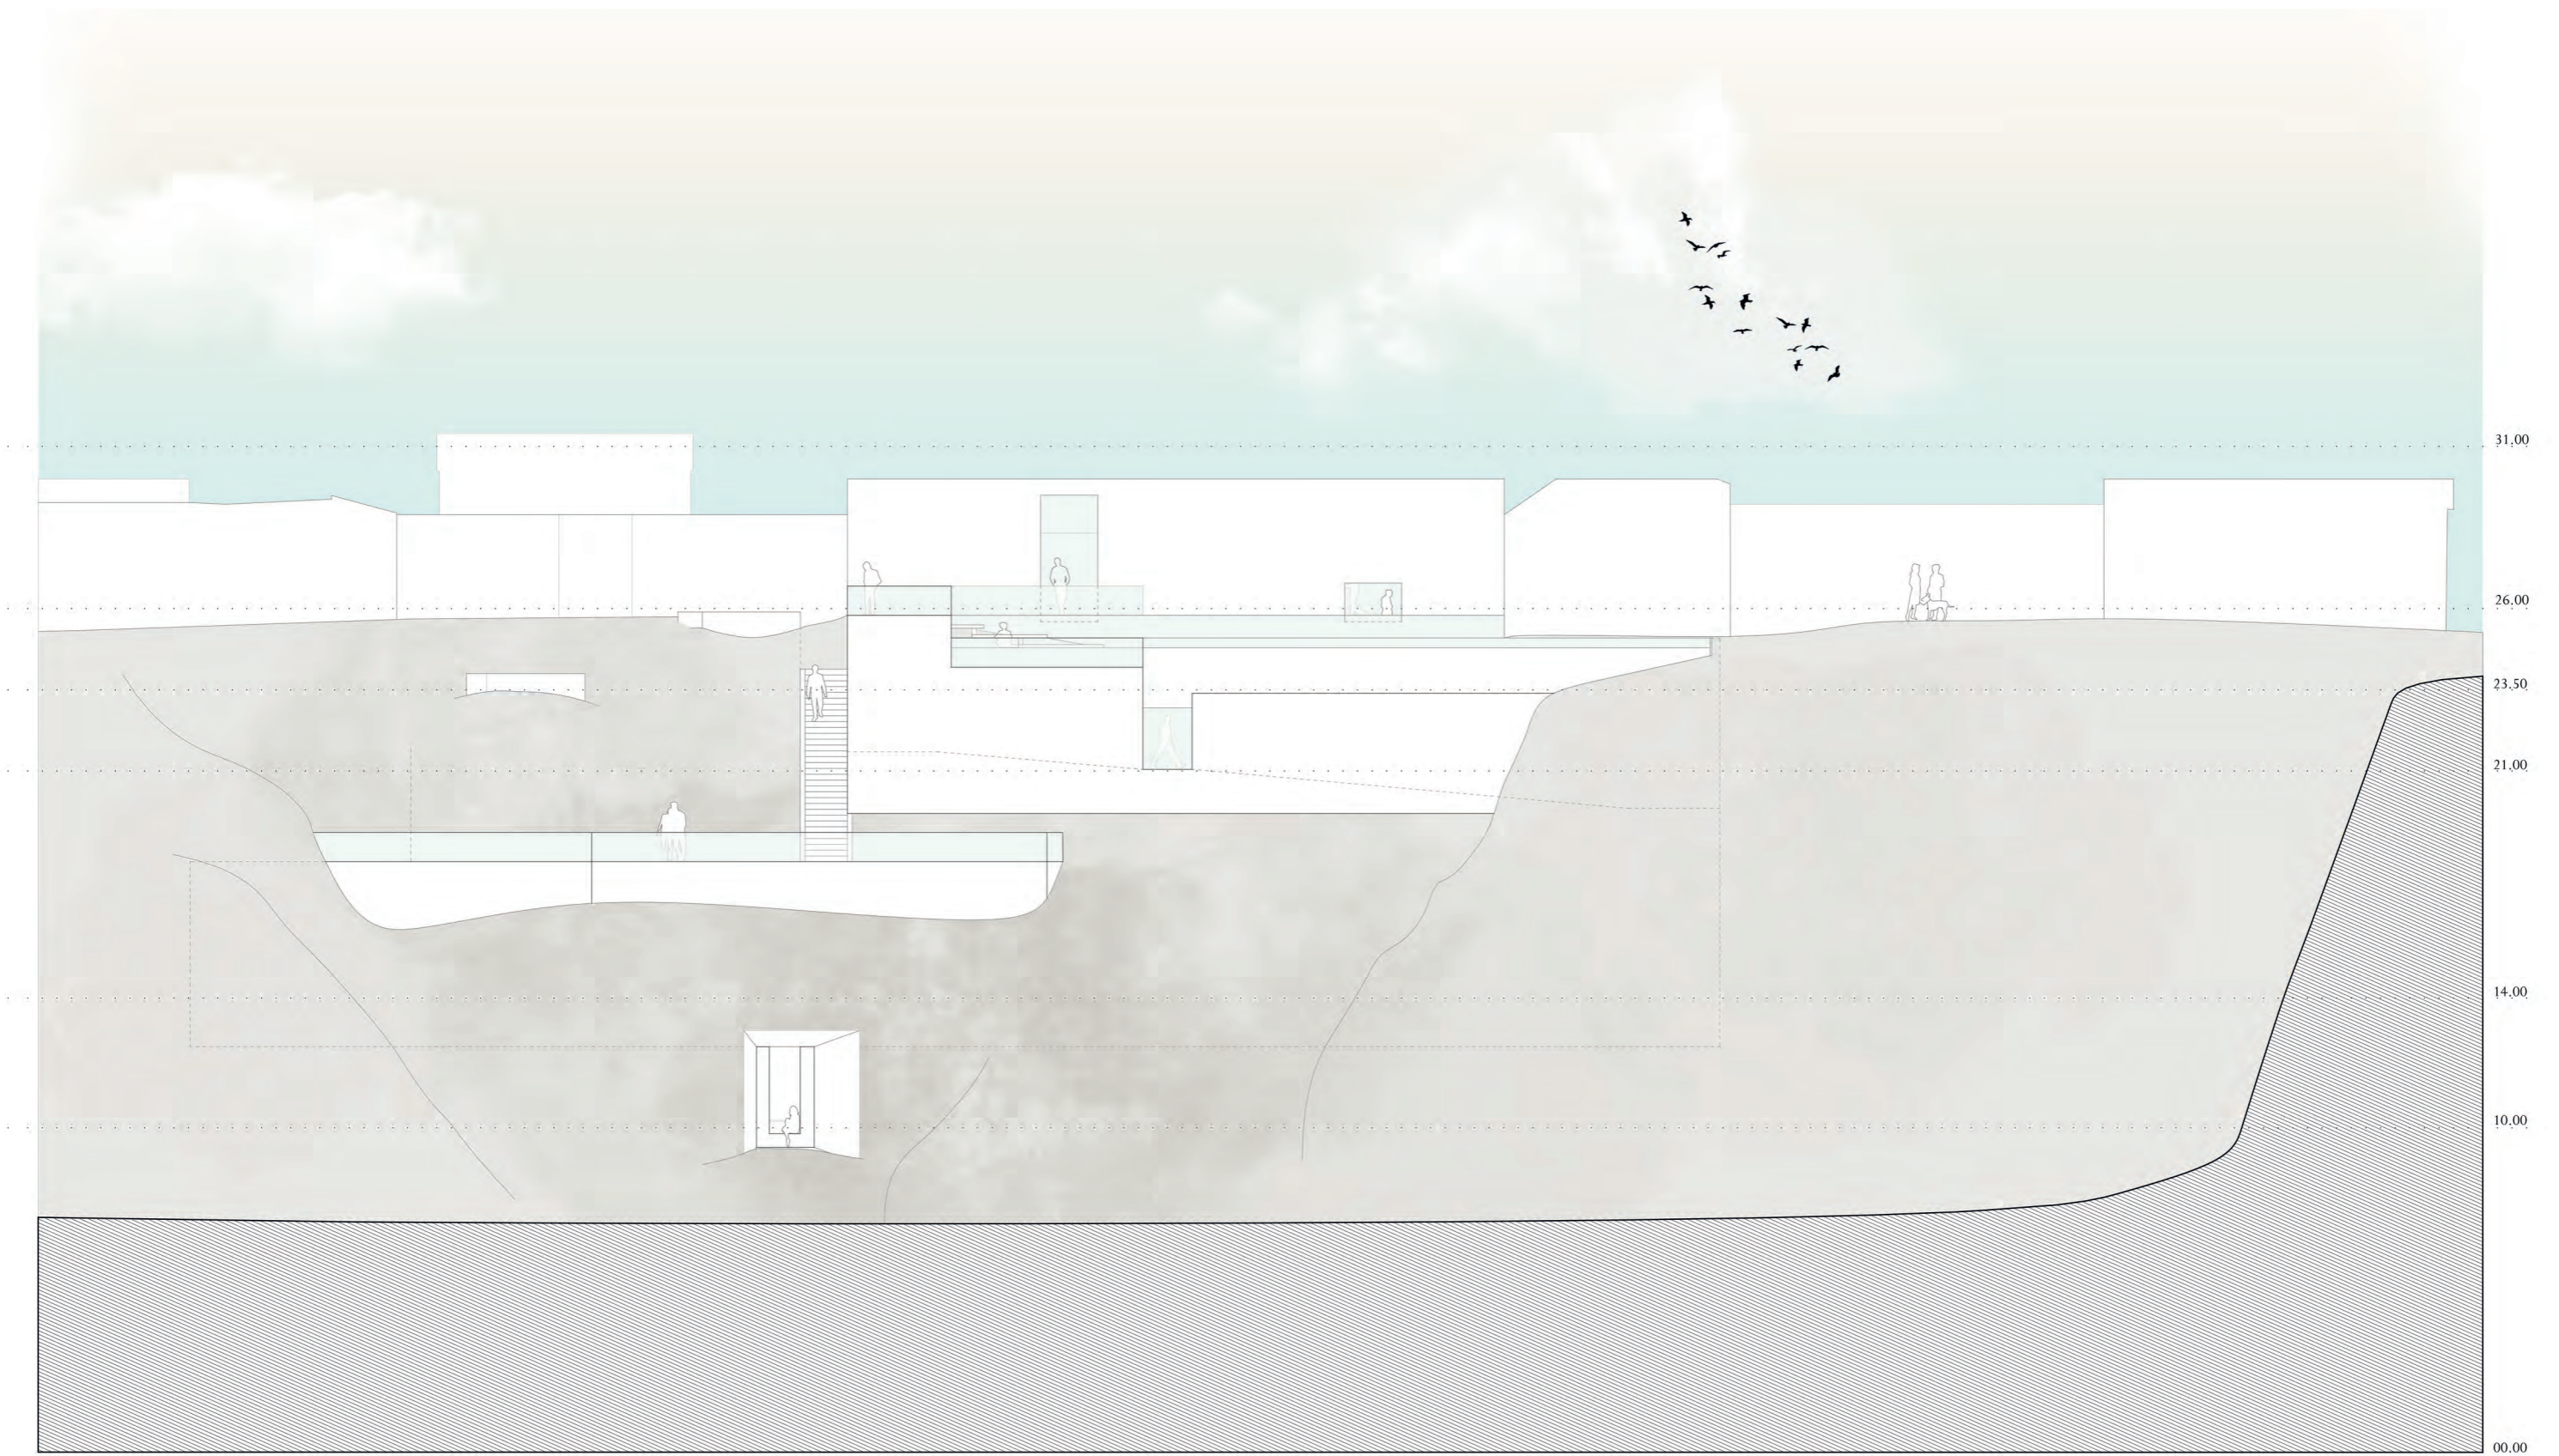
PROPOSTA - Corte transversal D - Alçado oeste (legenda em anexo). Escala 1.200
